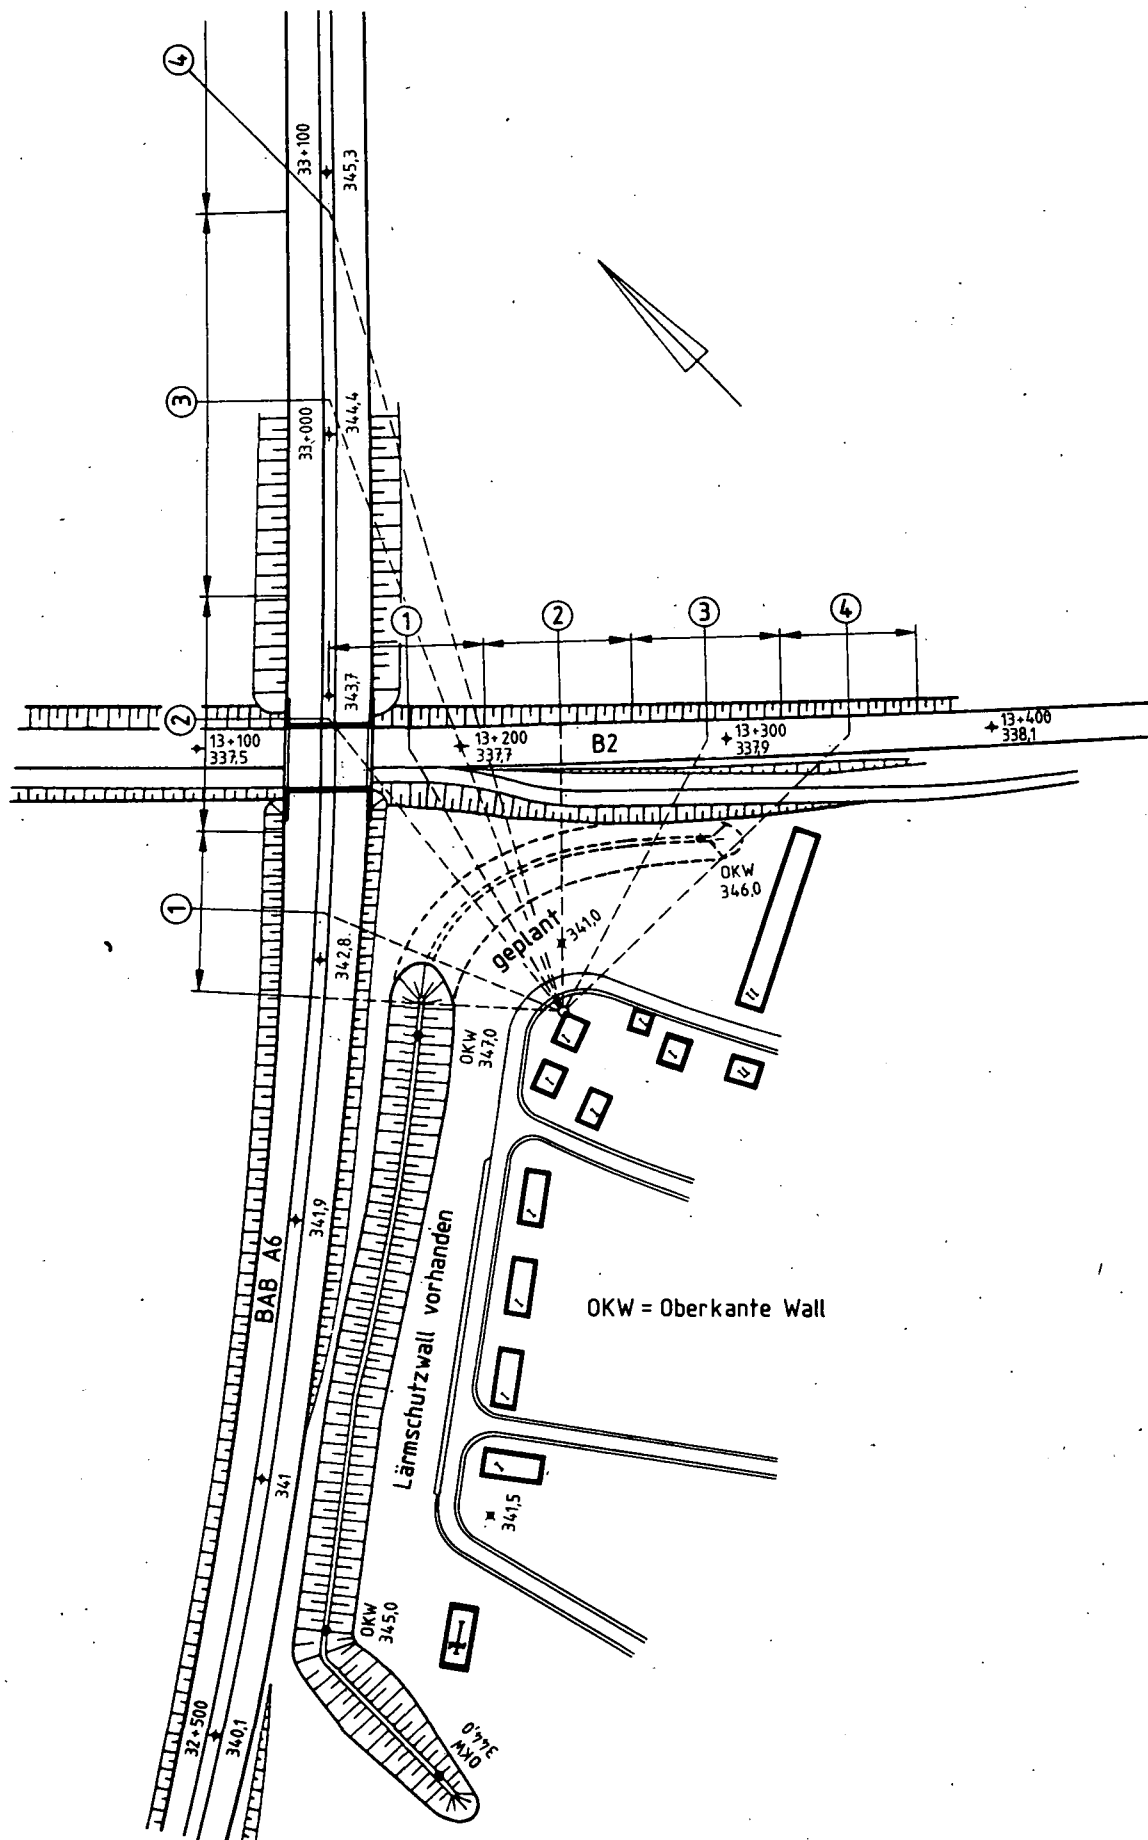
Baugebiet im Kreuzungsbereich einer Bundesautobahn und einer Bundesstraße (Lageplan)
